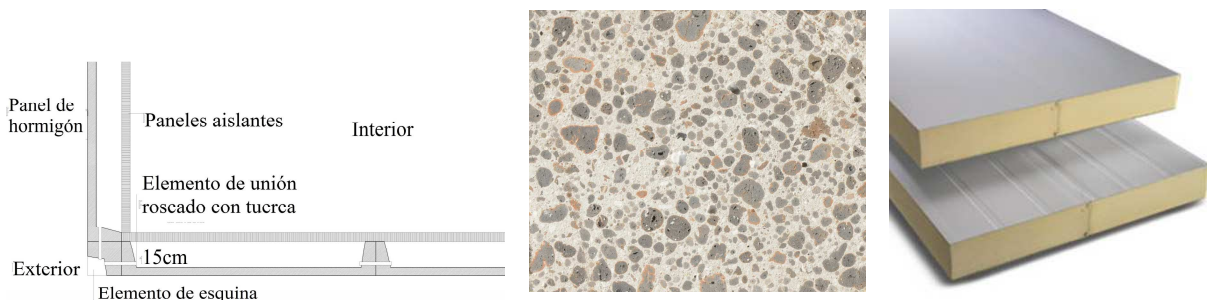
Izquierda. Planta: detalle de unión entre paneles verticales “U” y columnas perimetrales. Medio: detalle del HLAP. Derecha: paneles aislantes de poliuretano expandido con revestimiento exterior de chapa metálica en ambas caras.
